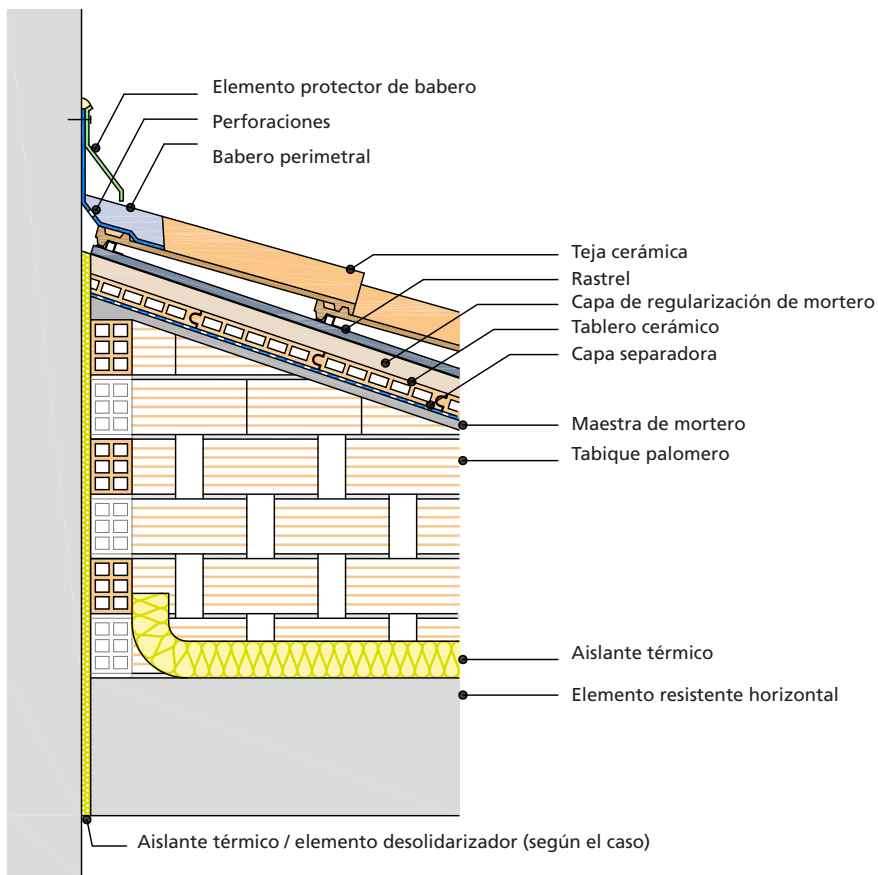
Encuentros de una cubierta QB12 con un paramento vertical
